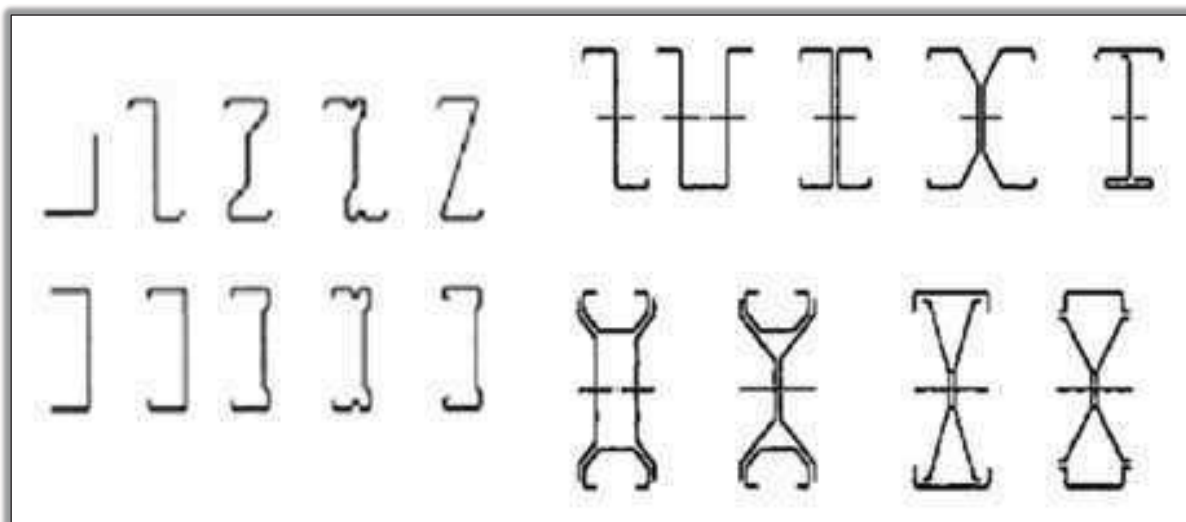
Exemples de Profilés ouvert simple et poutres formées à froid.
